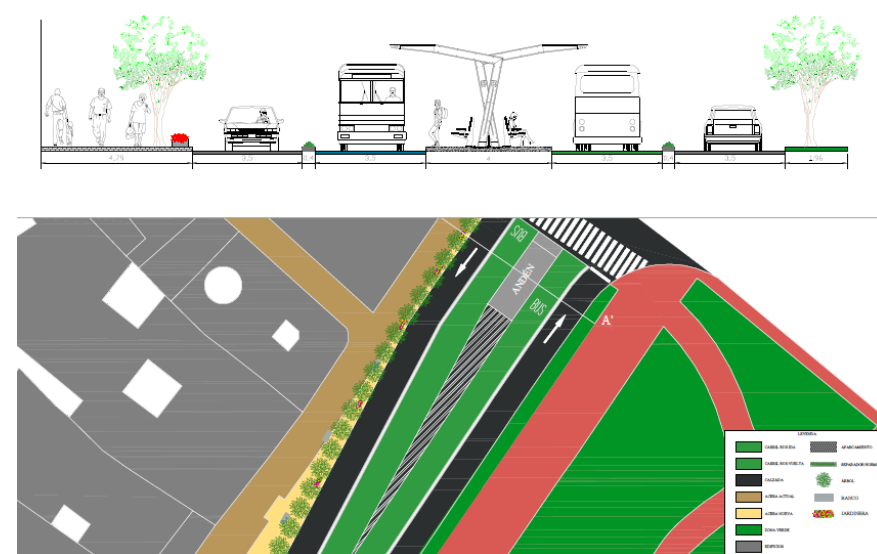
Planta y sección de la calle Cantón Pequeño.
